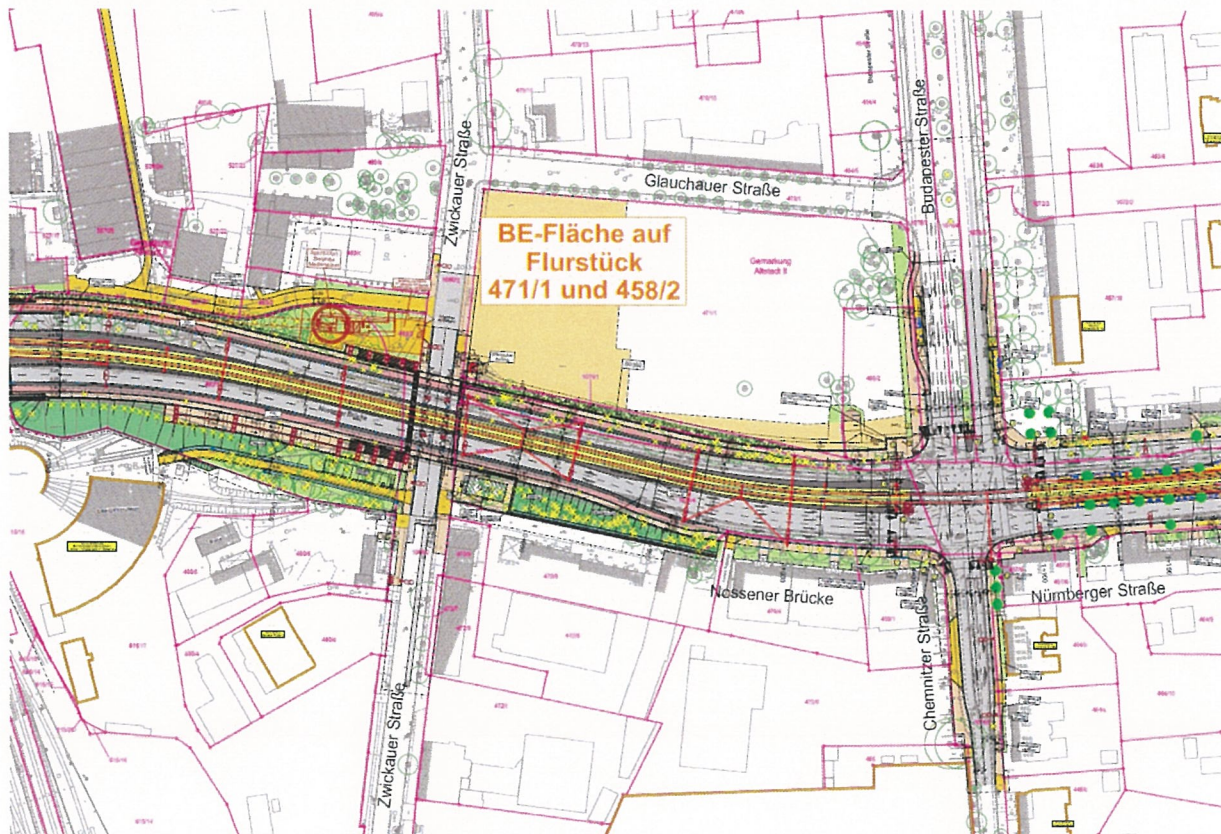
Lage der Baustelleneinrichtungsfläche
